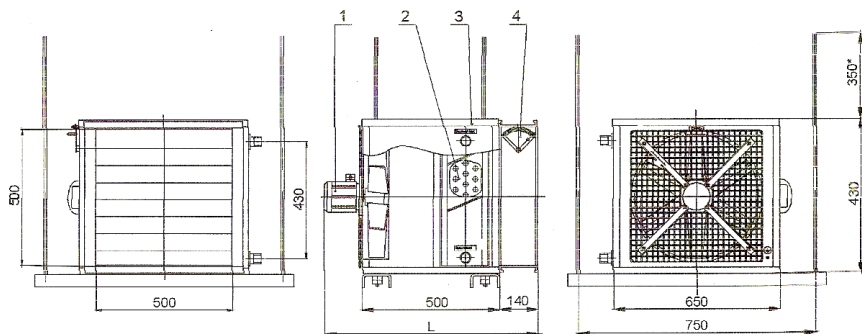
Агрегат отопительный АО: 1-вентилятор осевой; 2-воздухонагреватель; 3- корпус; 4-клапан воздушный
